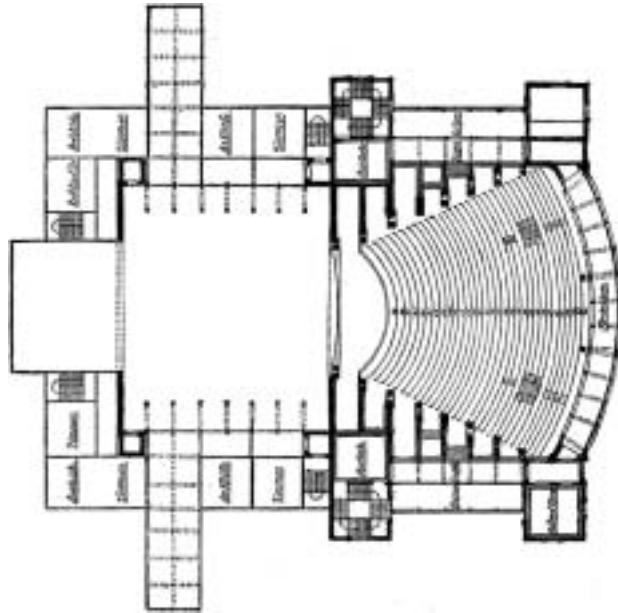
Grundriss des Festspielhauses. Deutlich ist die Zentrierung des Zuschauerraumes auf den Mittelpunkt der Bühne und nicht die Bühnenvorderkante zu erkennen.
